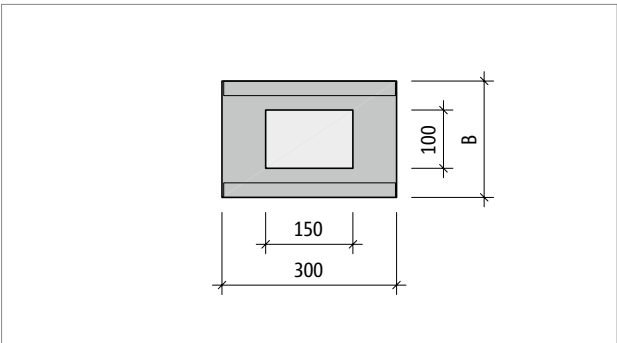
Schöck Sconnex® Typ W-N: Produktgrundriss; Drucklagerfläche 150 mm × 100 mm
